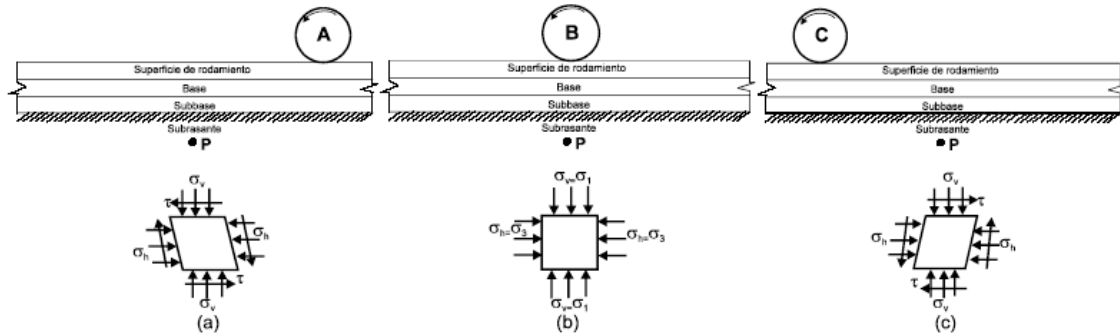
Estado de esfuerzos en una sección longitudinal de un pavimento. Referencia, (28).
